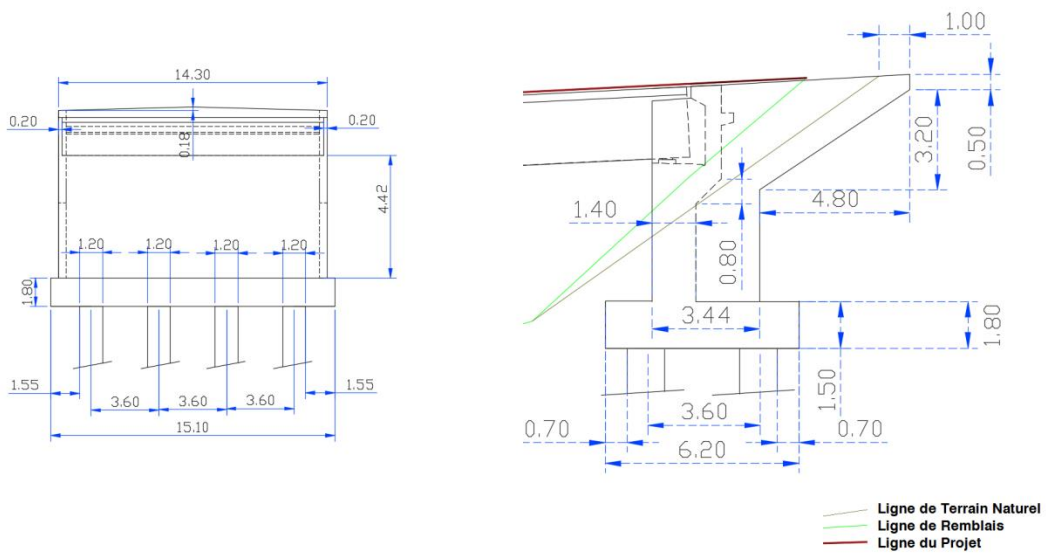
Coupe transversale, et longitudinale de la culée Sud.
